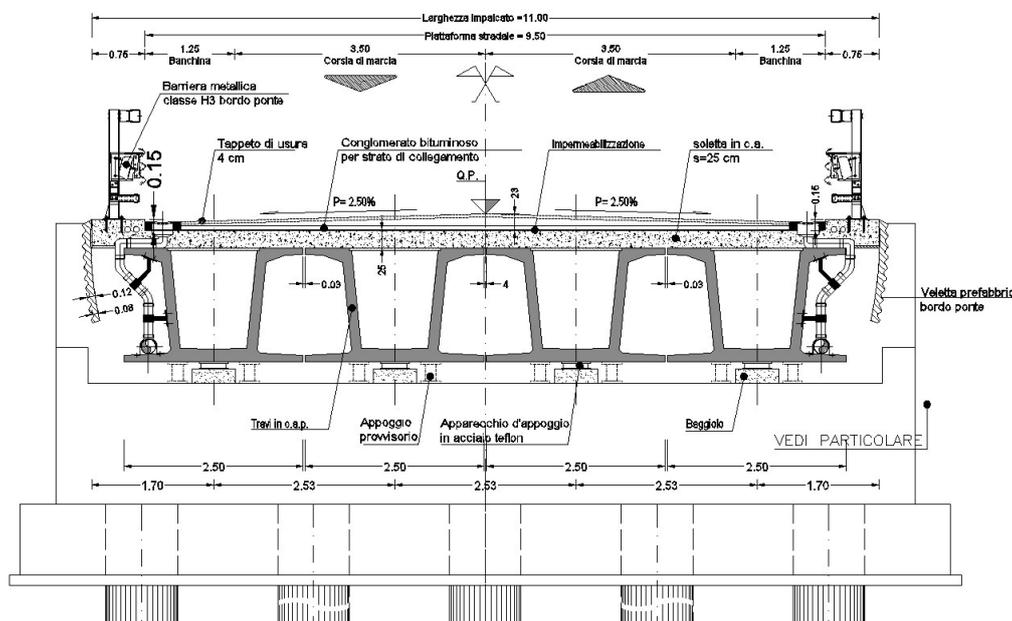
SS.260 - Lotto V - Esempio sezione ponte
